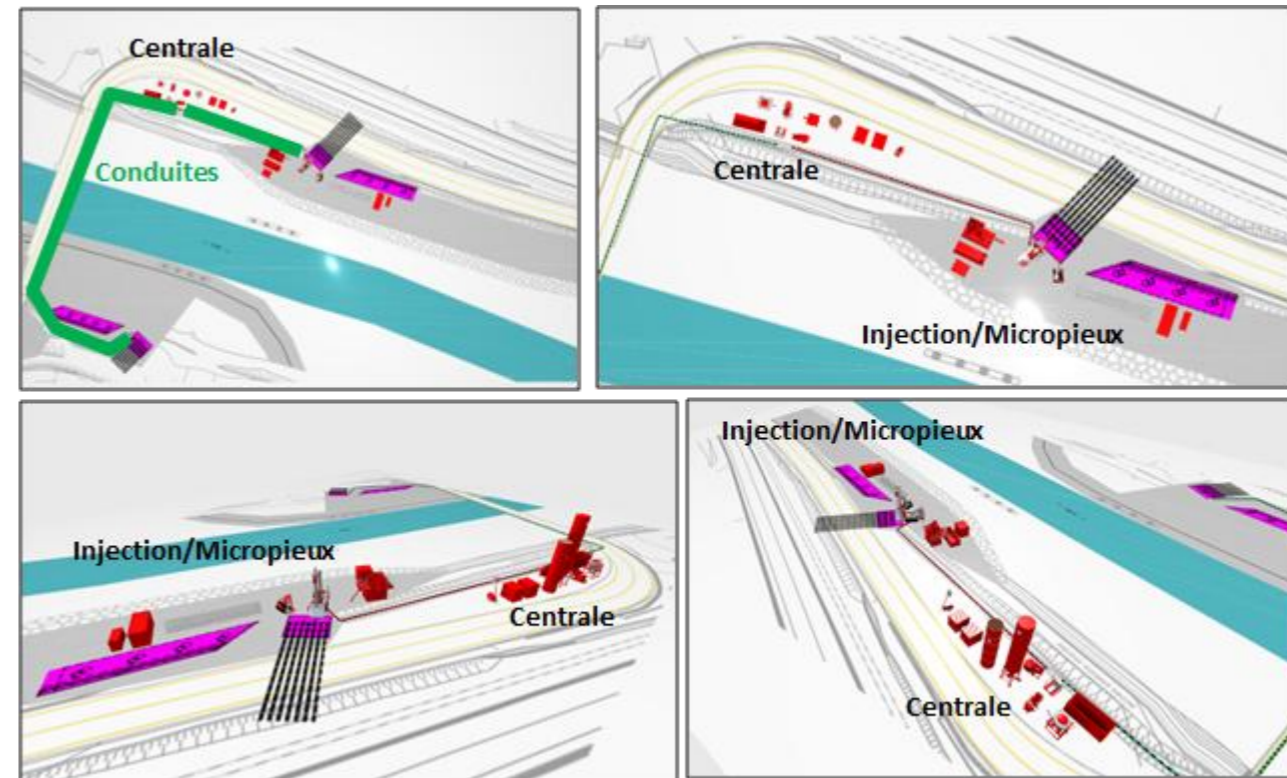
Plan d'installation de l'atelier d'injection/micropieux rive gauche
